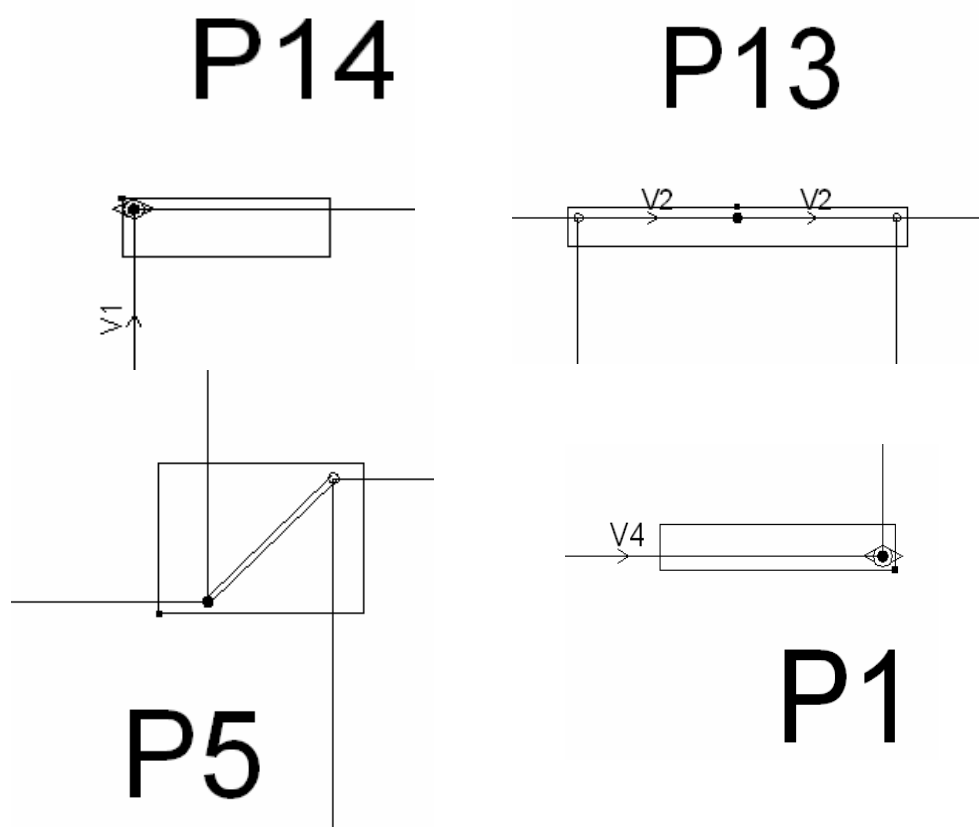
Detalhe de algumas ligações entre vigas e pilares.
